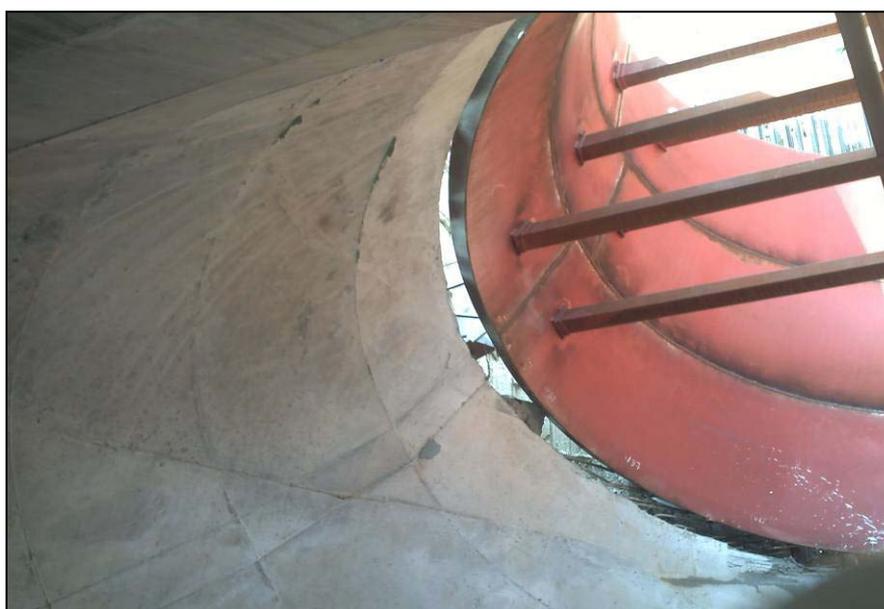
Central. Grupo 2. Vista do cotovelo e do betão de transição
